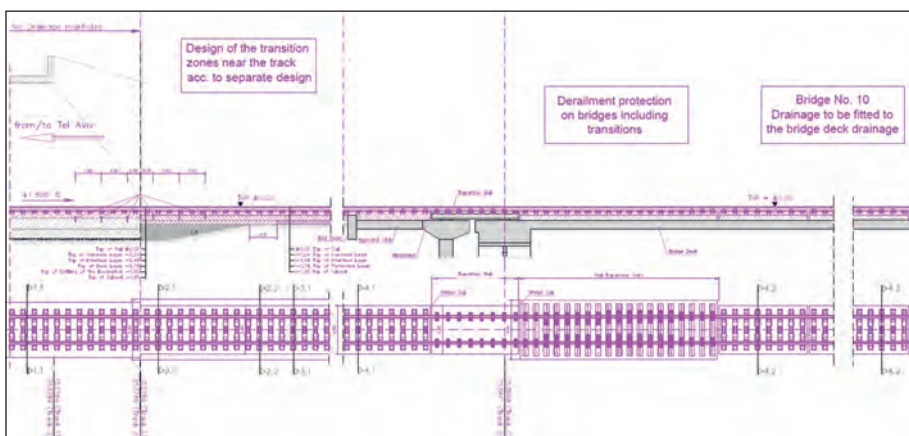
Übergangsbereich Tunnel 3A – Brücke 10 gemäß Entwurfsplanung [2]
